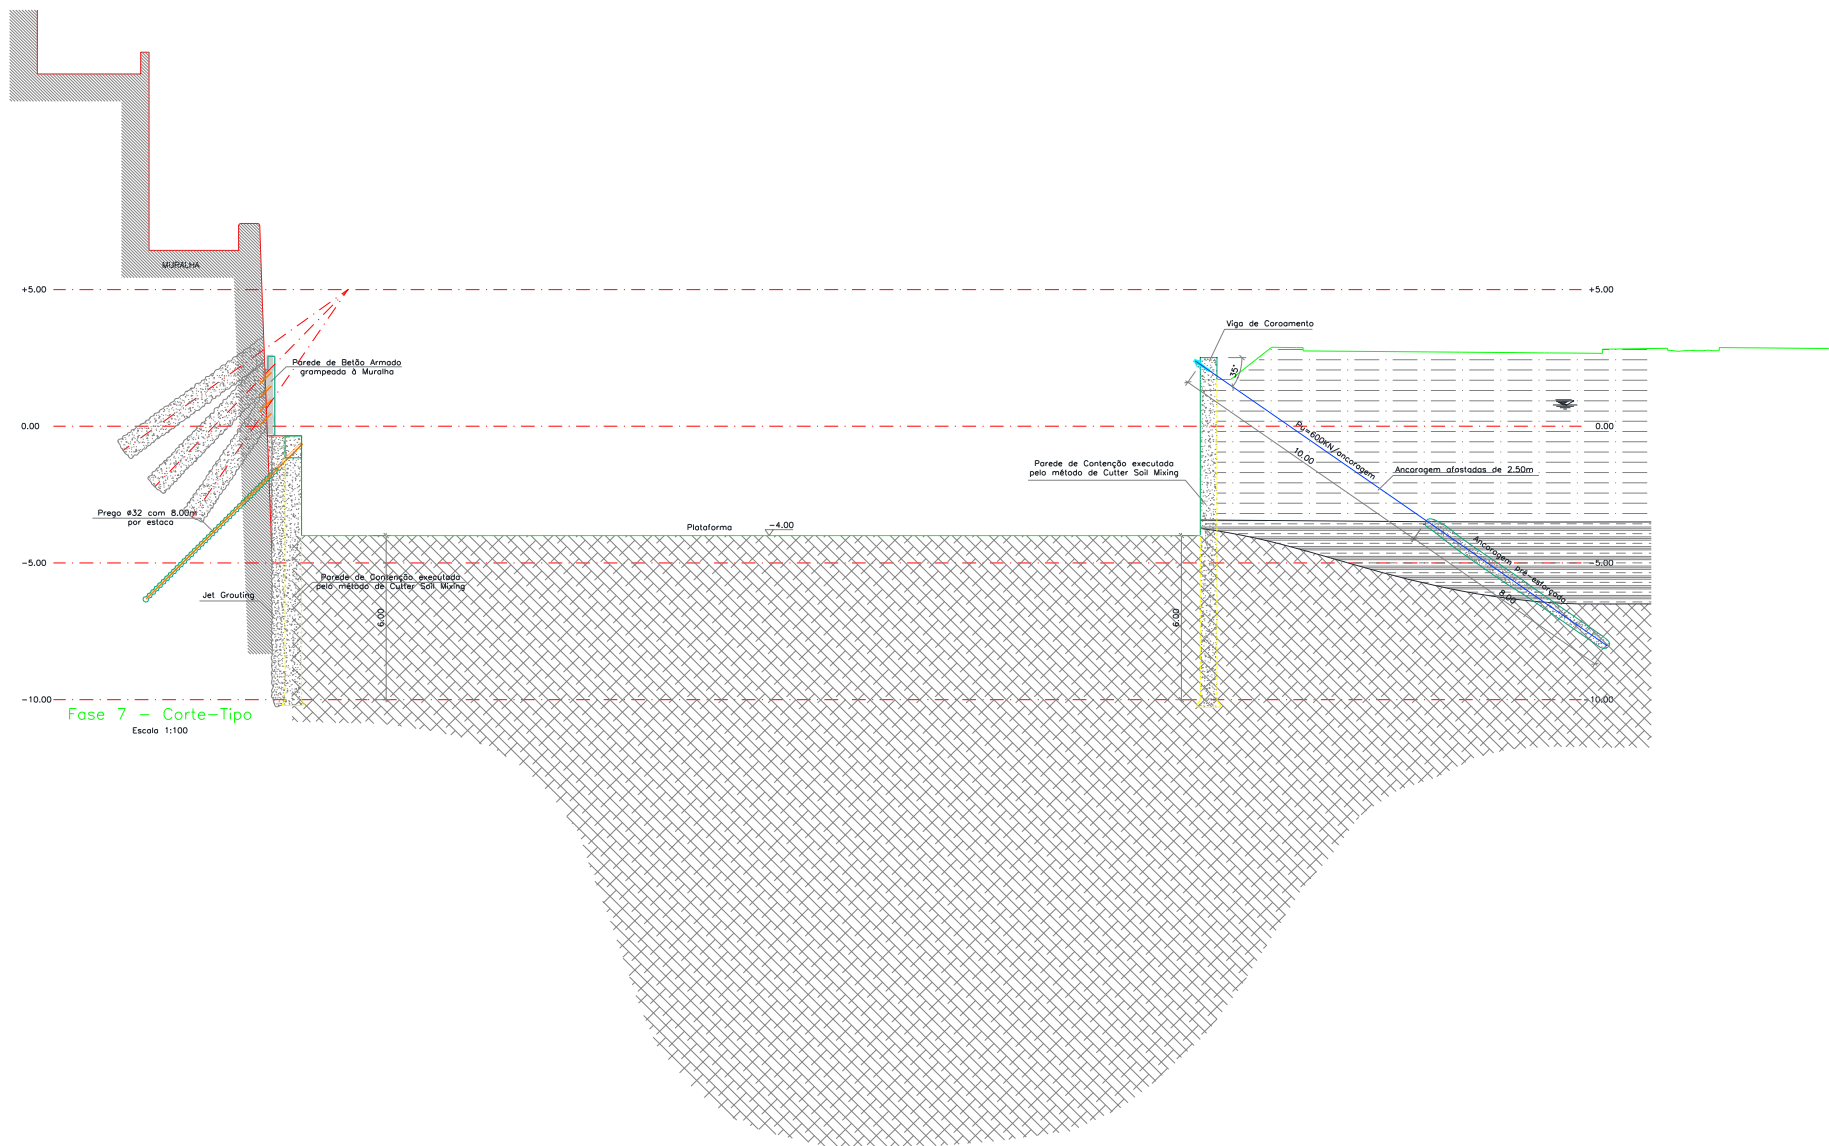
Corte construtivo - “Jet Grouting” entre a muralha e a estrutura de contenção [29].
